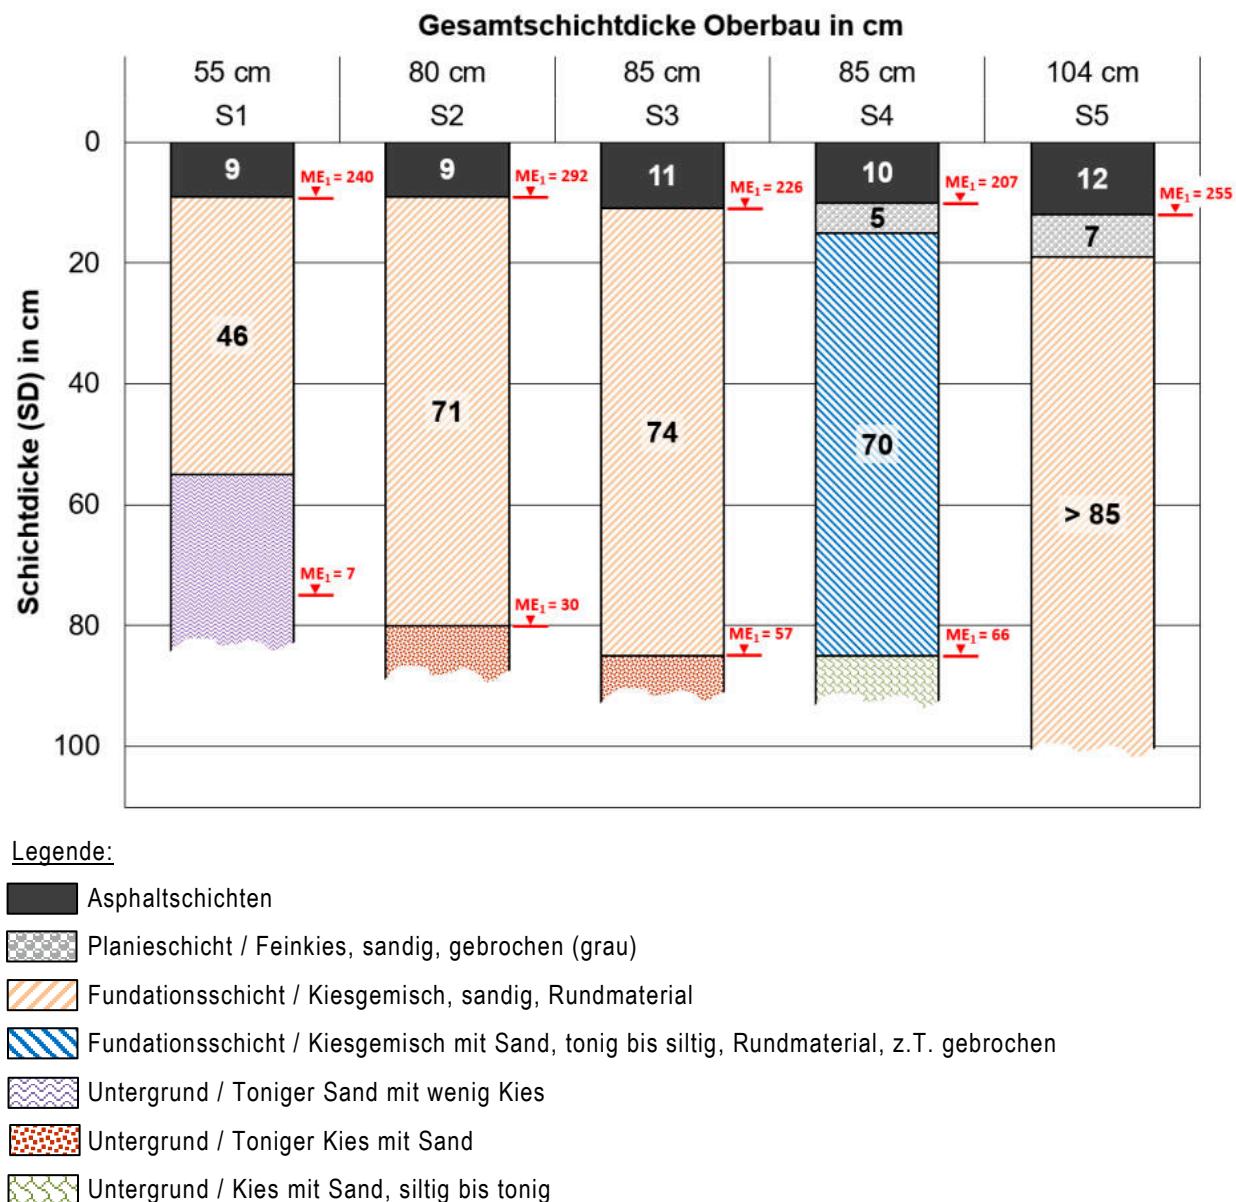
Gesamtschichtenaufbau Oberbau und Unterbau / Untergrund inkl. Ergebnisse der Platten-druckversuche (rote Zahlen)
